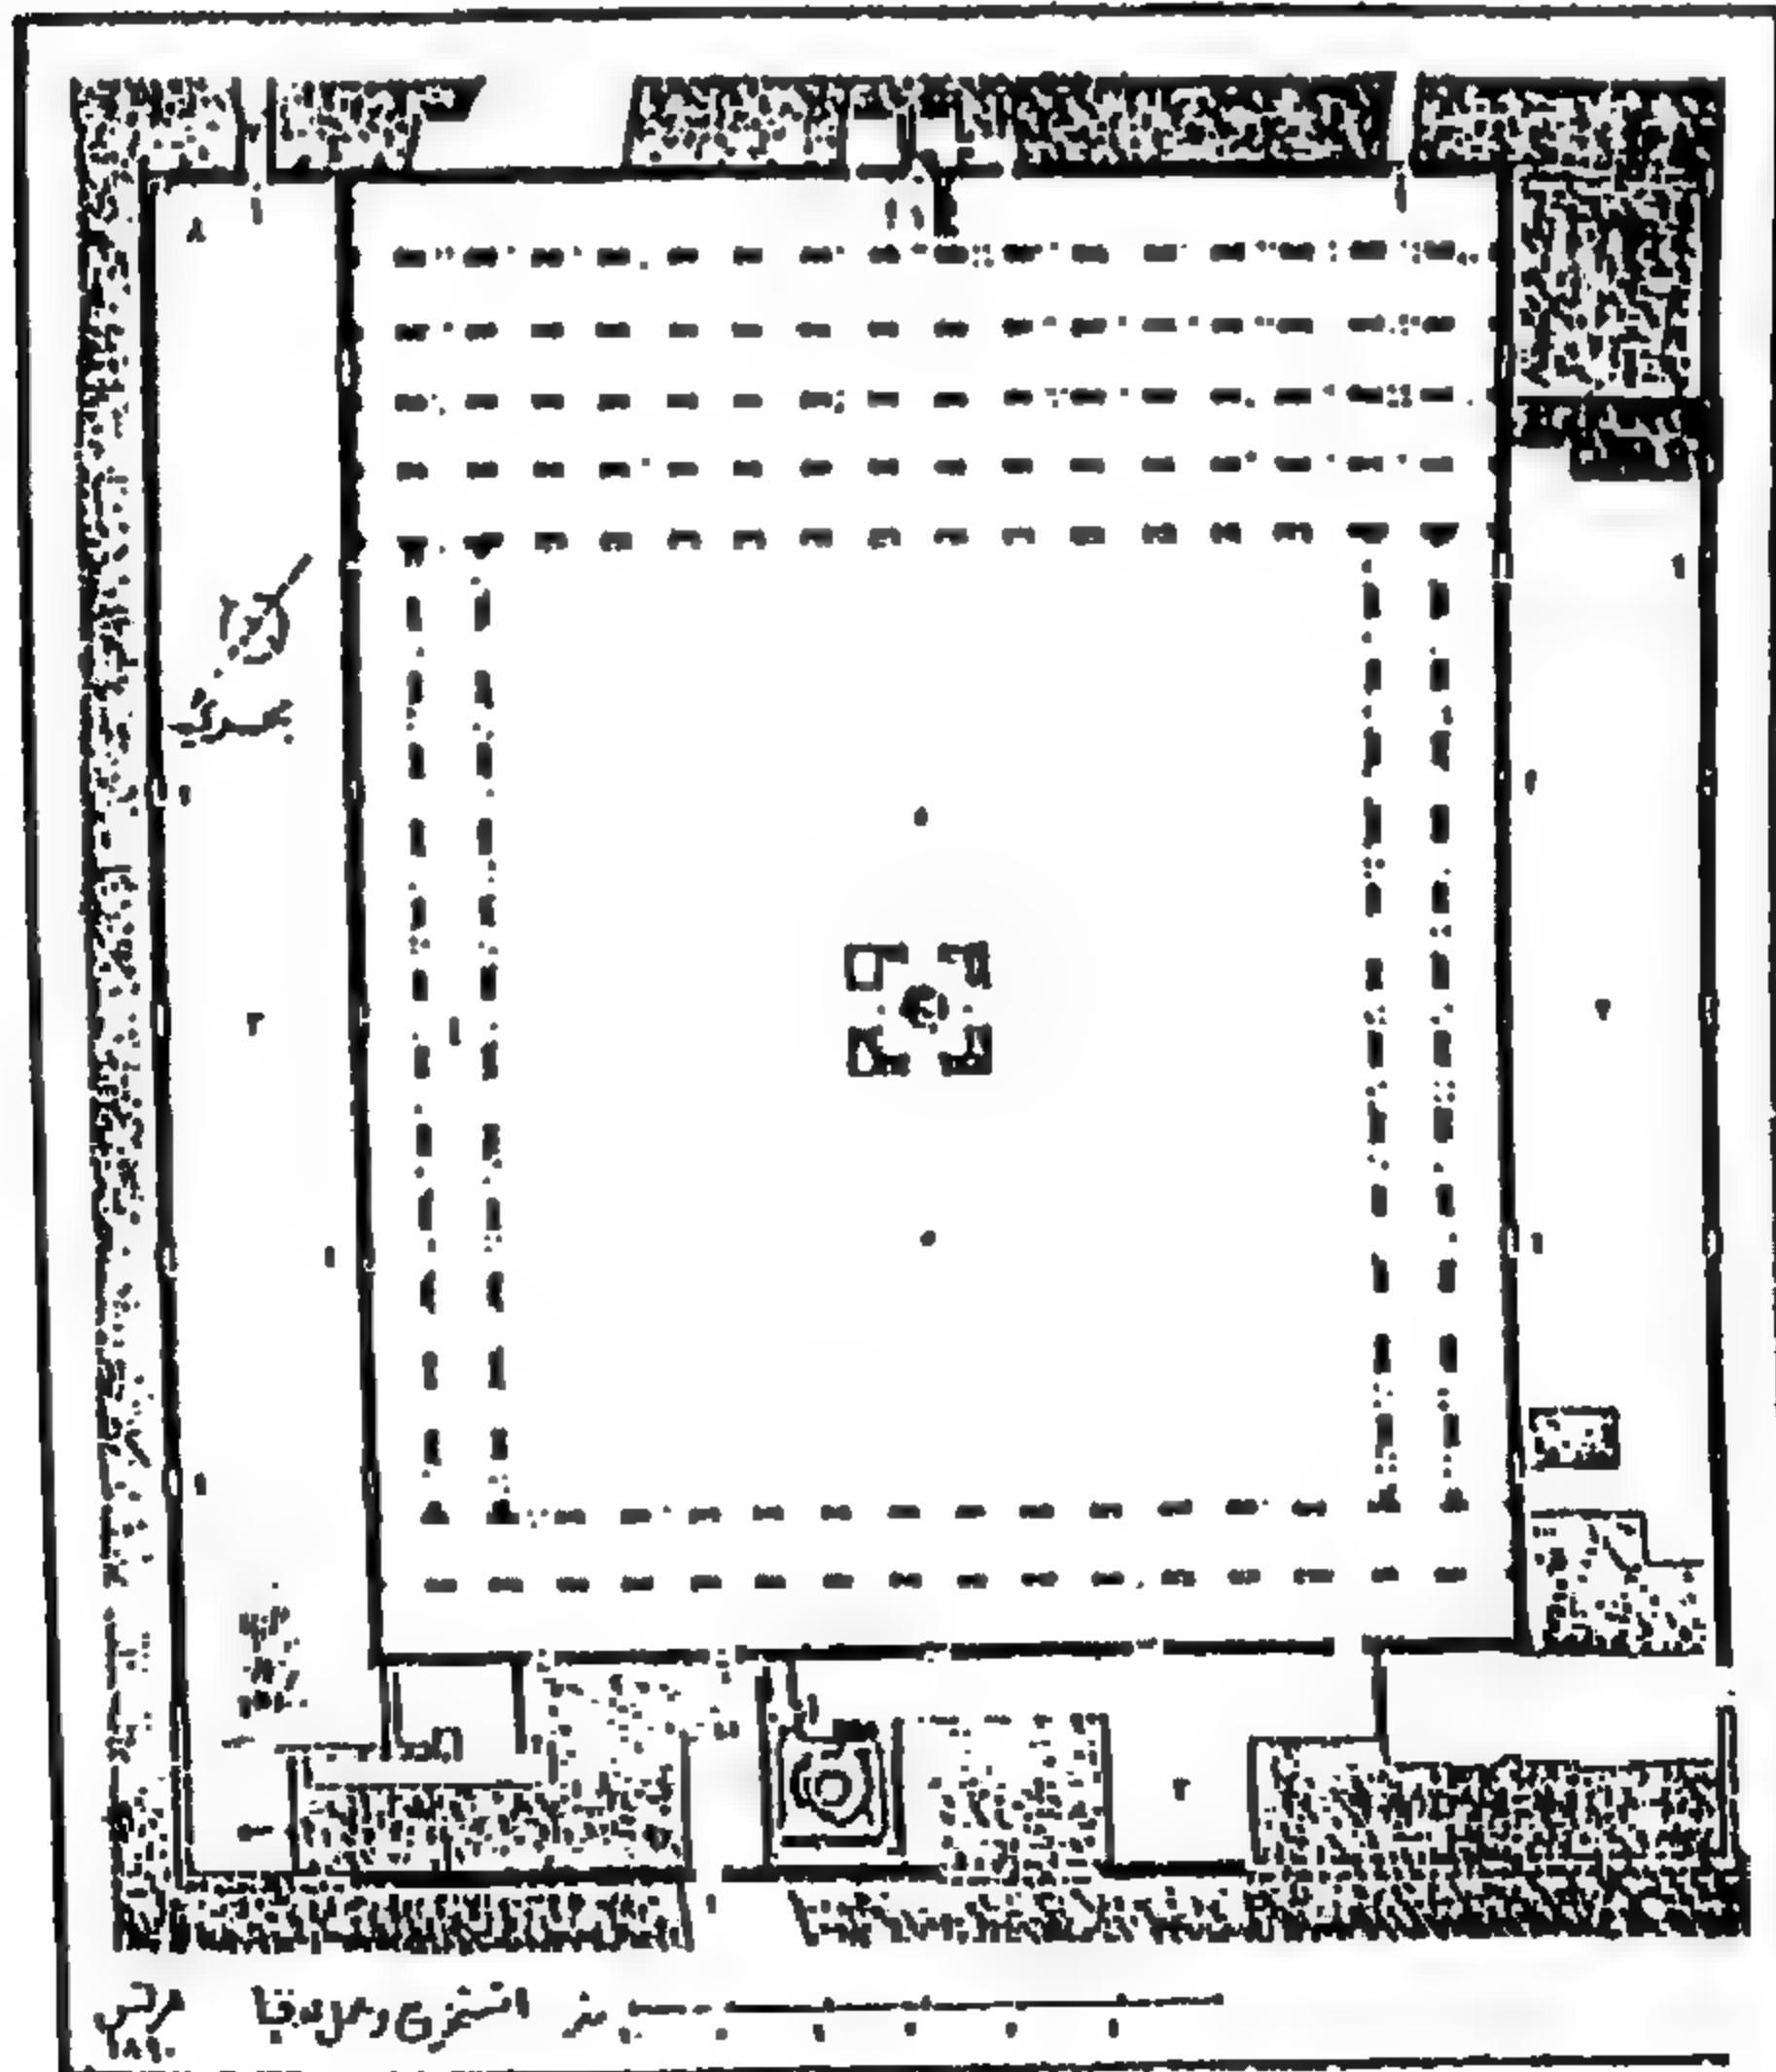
مسقط أفقي للجامع الأزهر الحالي (عن : Creswell)
